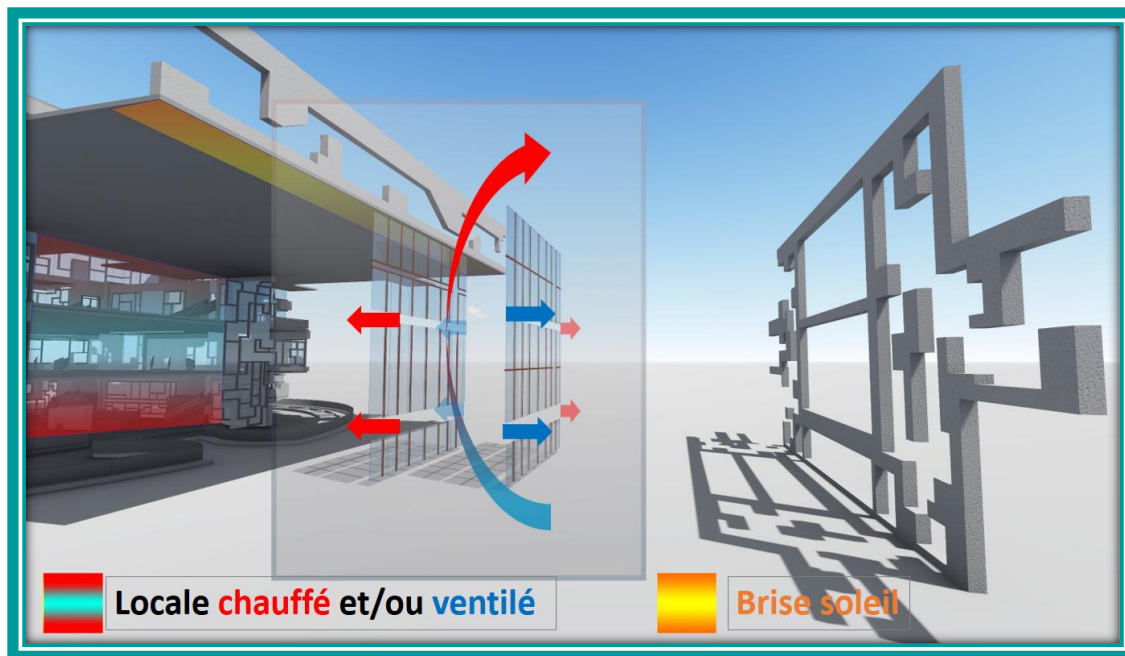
schéma explique la façade double peau ventilée / source: auteur
